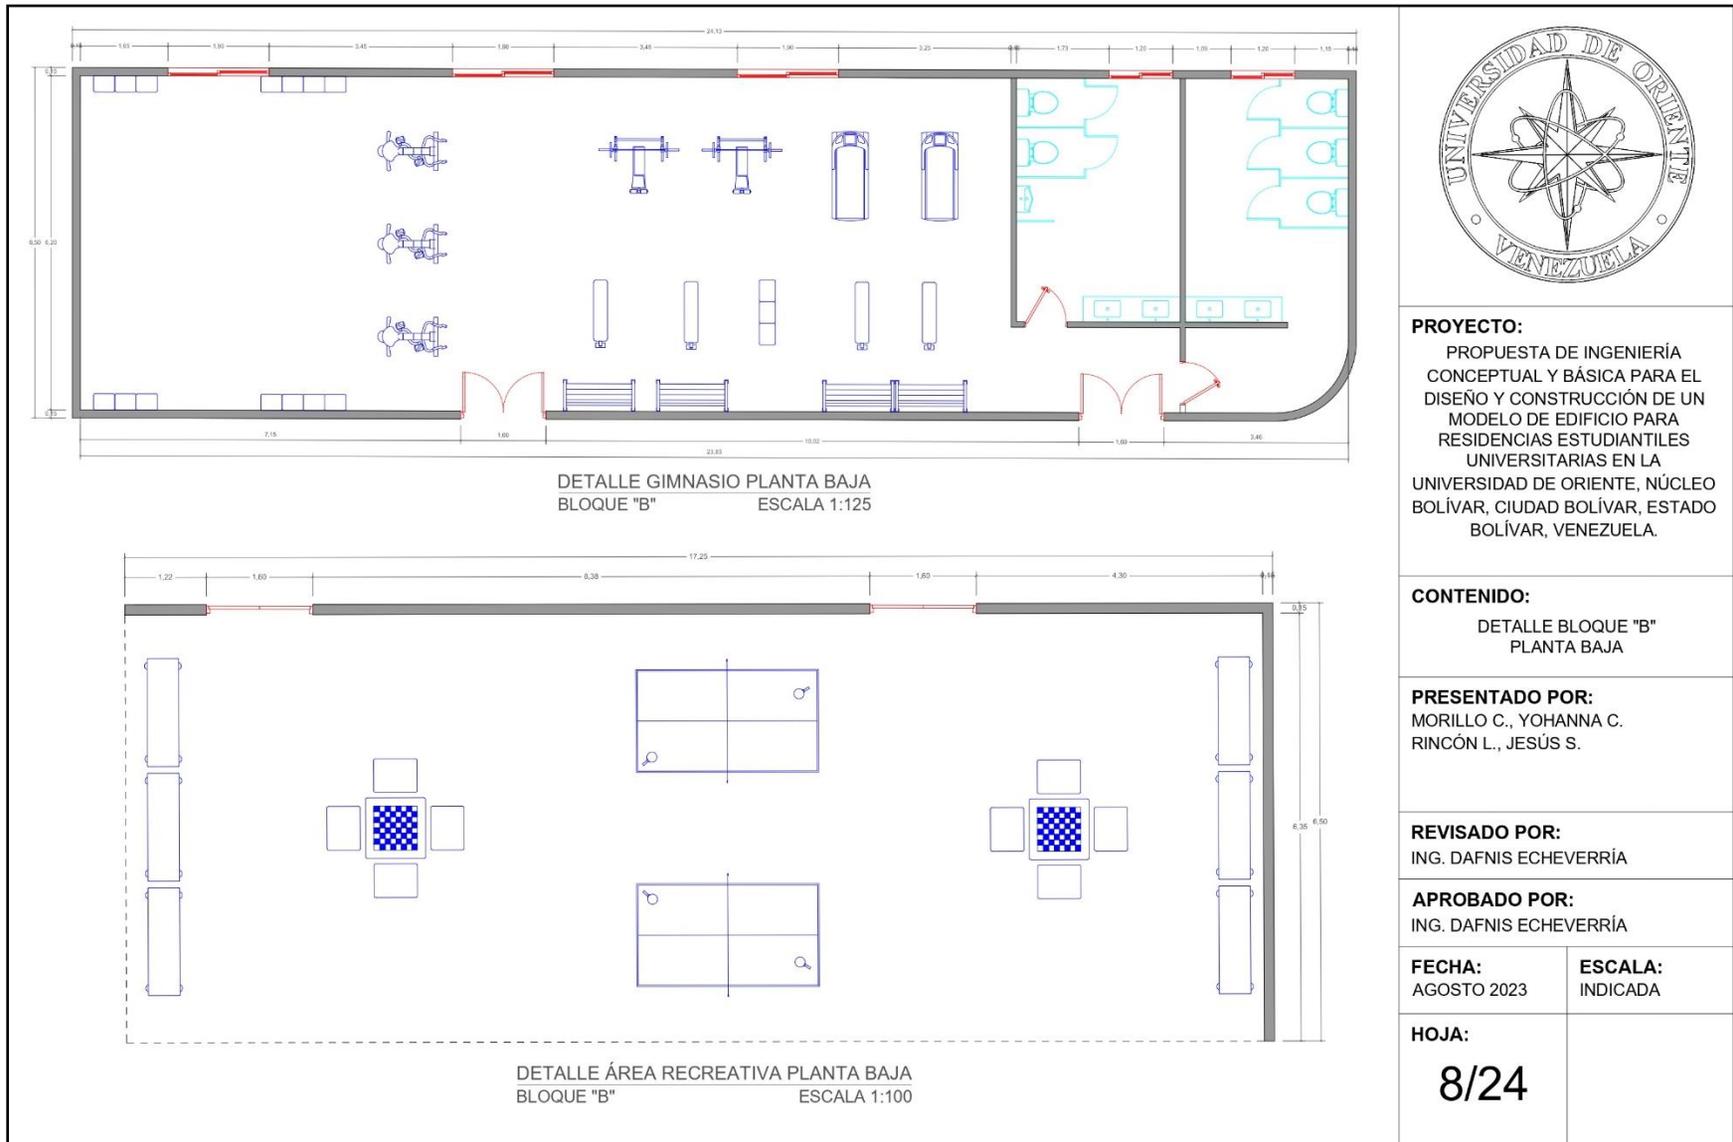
Plano de Detalle. Bloque “B”, planta baja.
